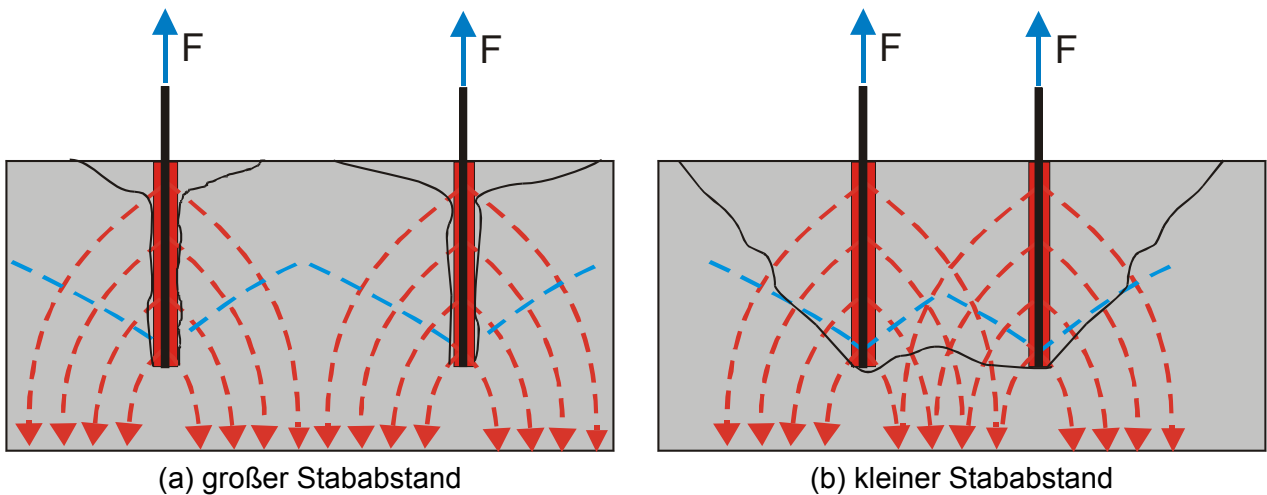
Verankerungen ohne Abstützung gegen eine Betondruckstrebe mit Lastweiterleitung über Betonzugspannungen
